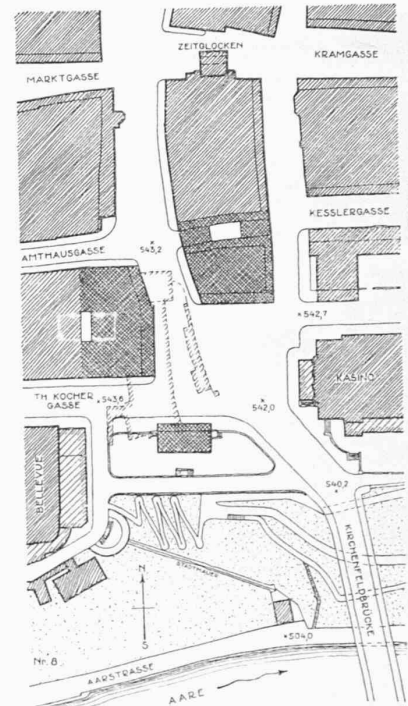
Lageplan 1:2500 zu Nr. 8.
